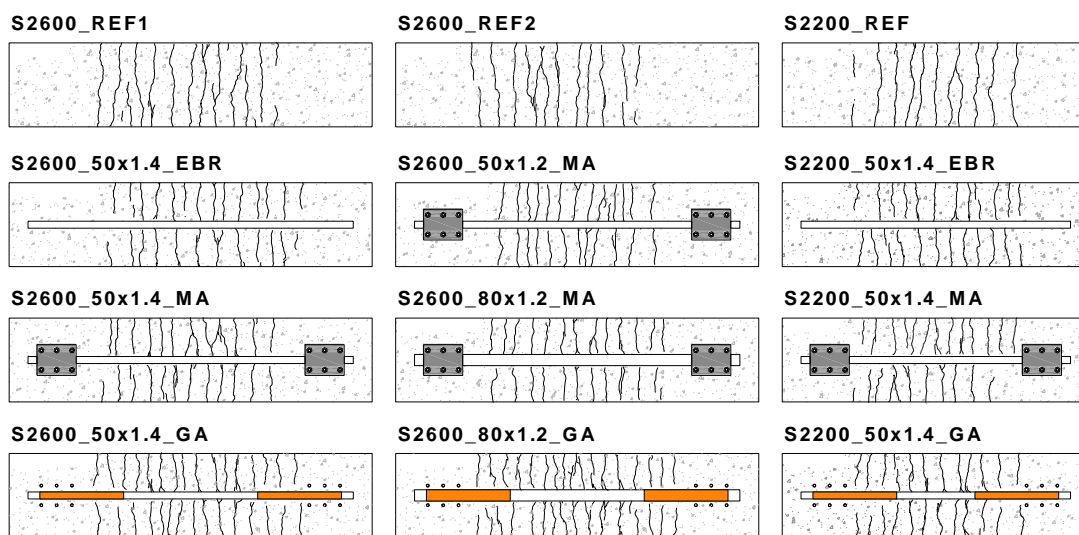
Padrão de fendilhação para as lajes ensaiadas.
